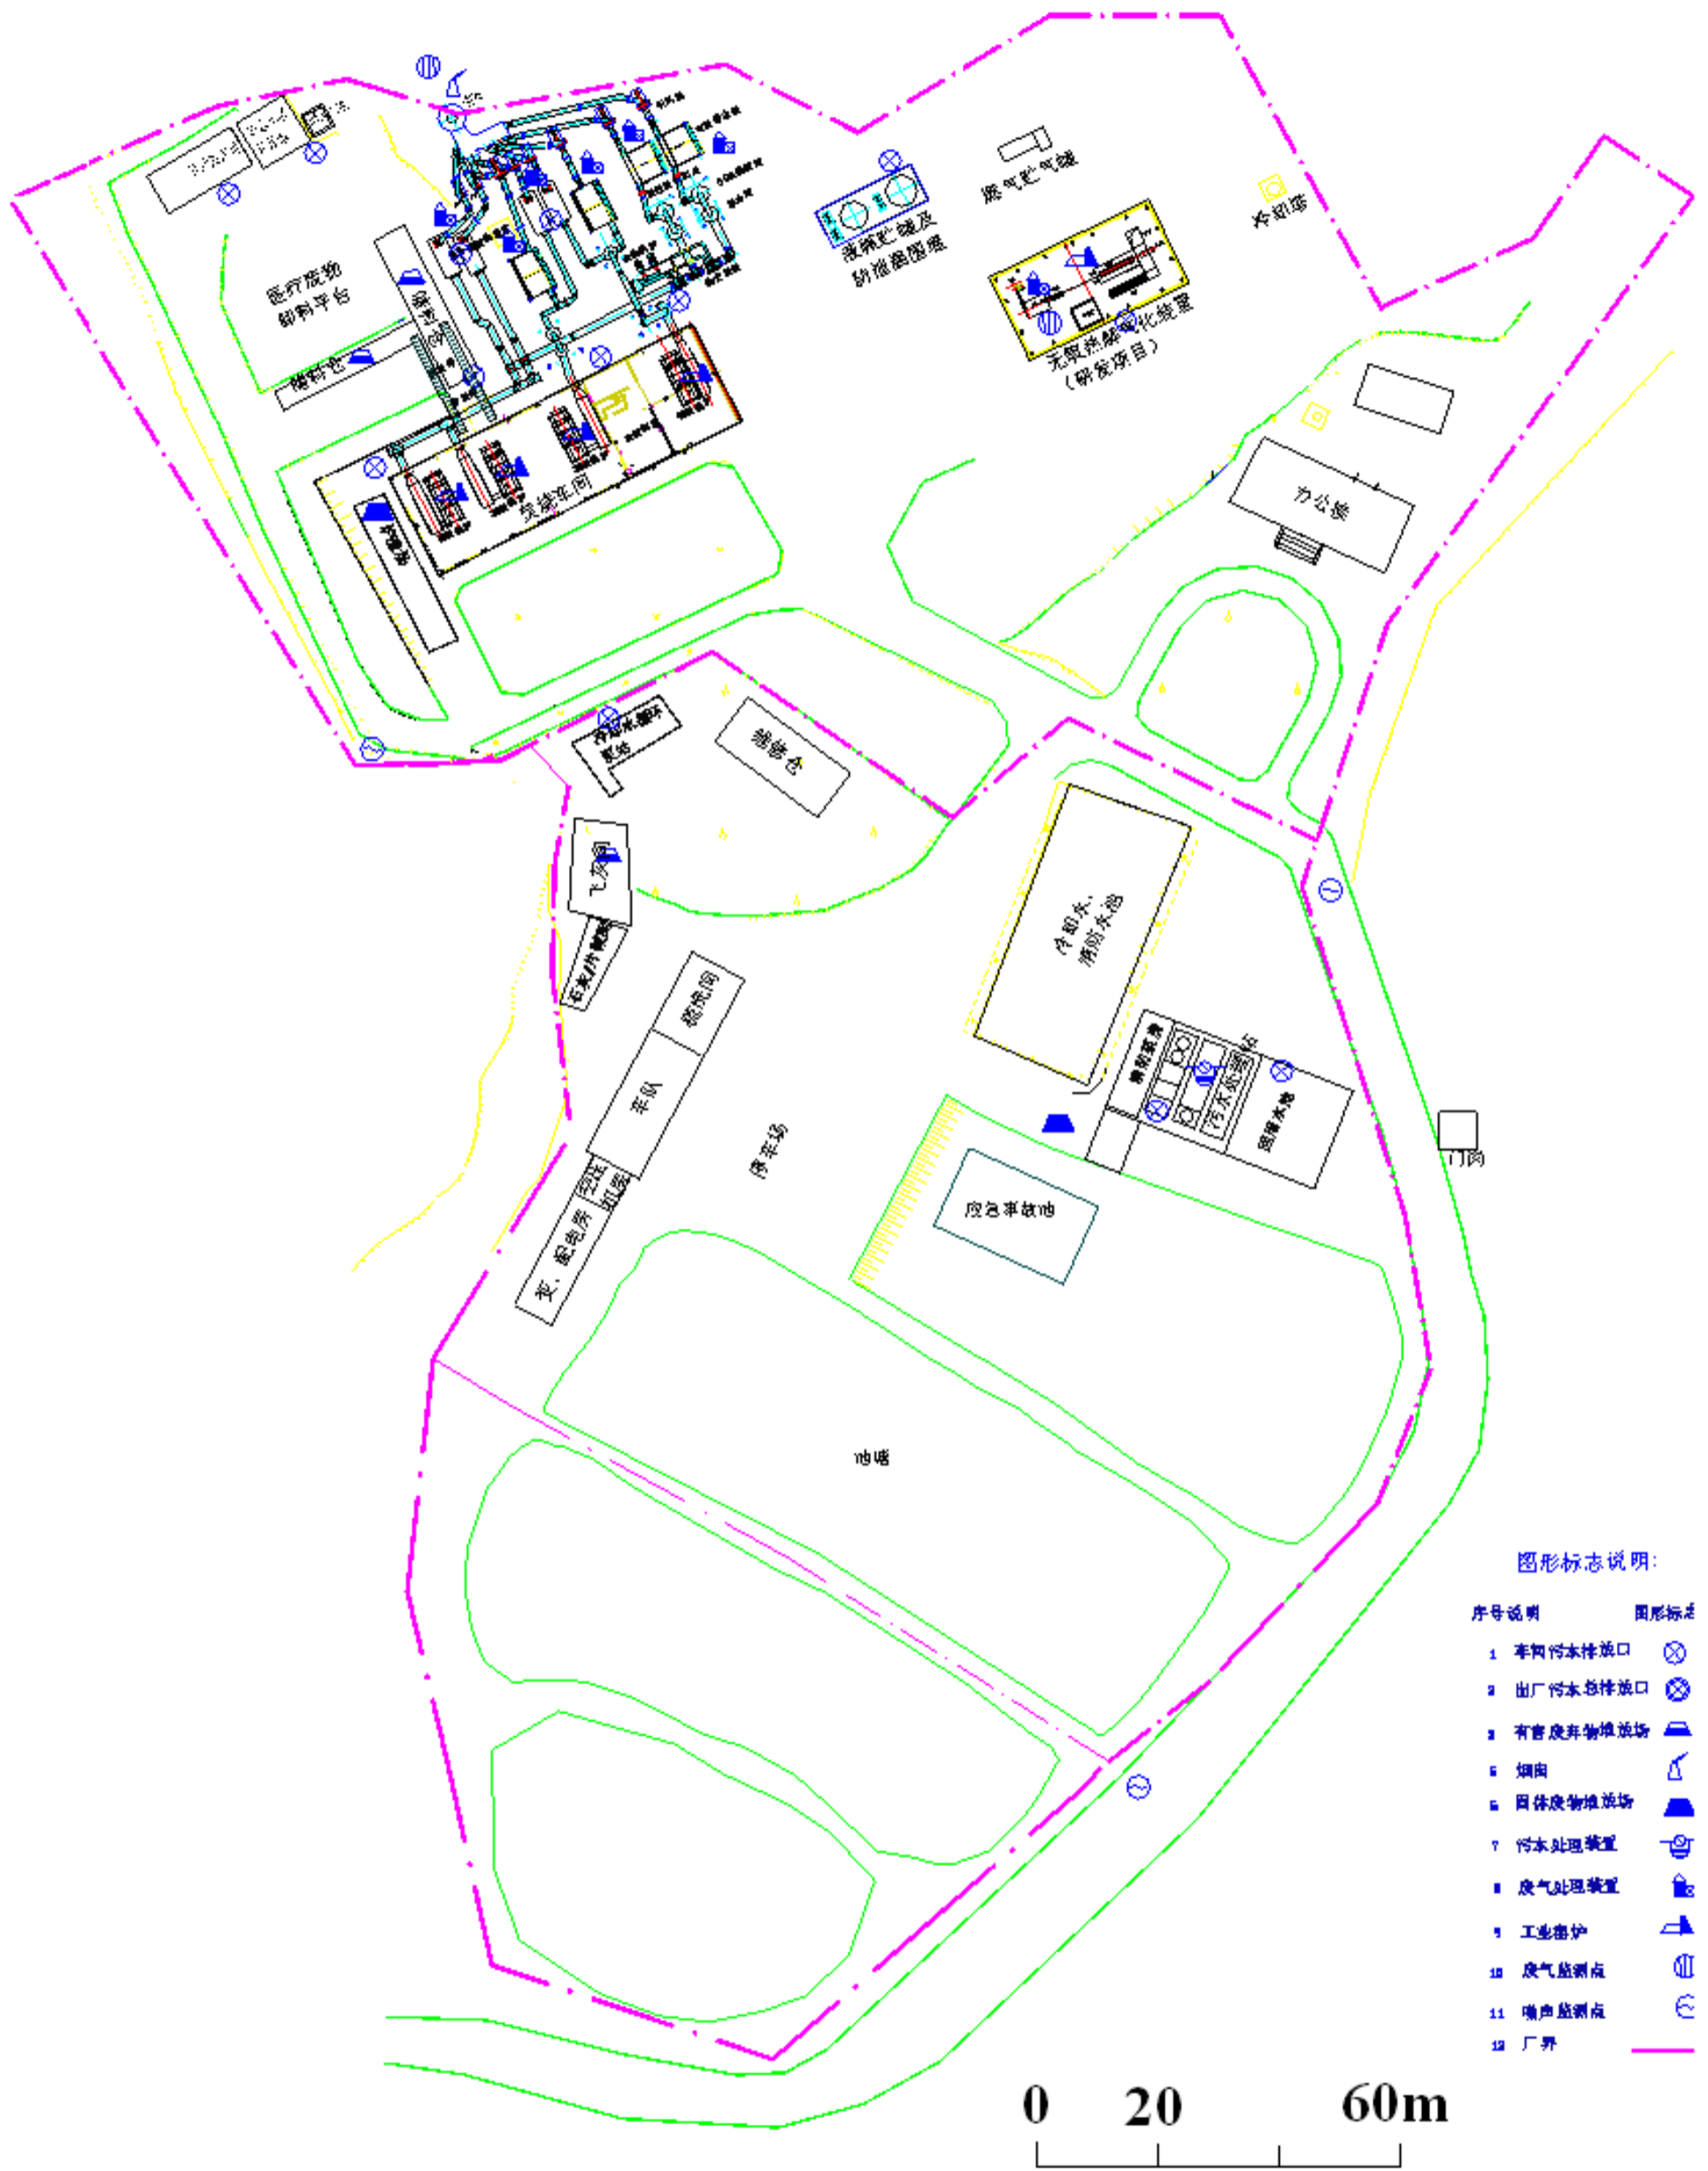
现有项目总平面图 (含污染治理设施、风险防范设施)
